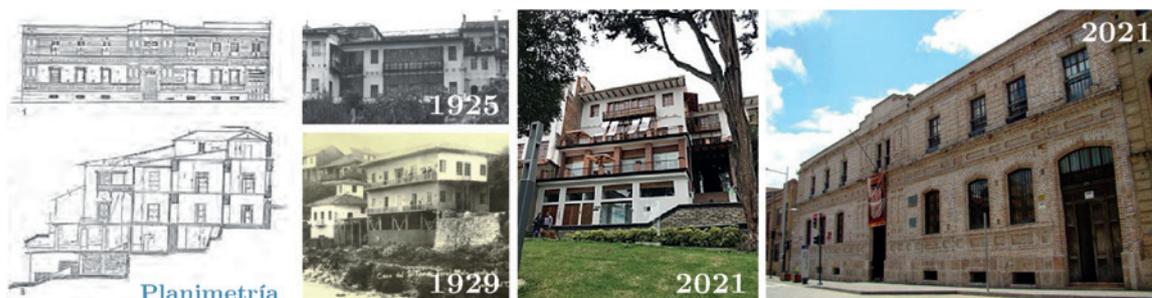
Transcurso constructivo Casa Museo Remigio Crespo. Fuente: [Kennedy \(2007\)](#). Elaboración: Autora.
